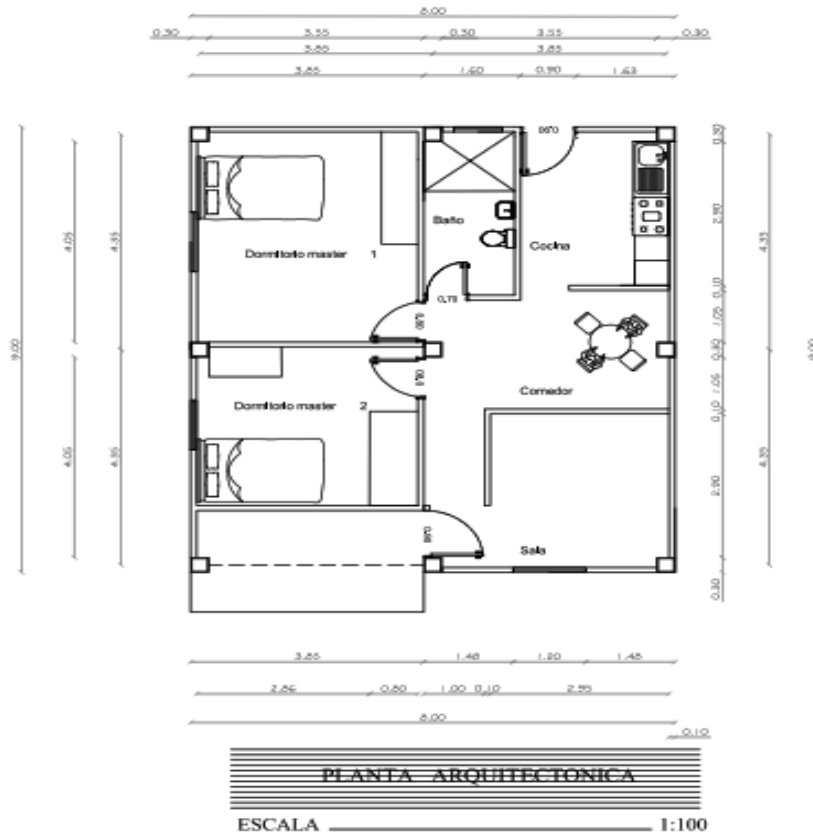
Planta Arquitectónica Fuente: Elaboración propia
